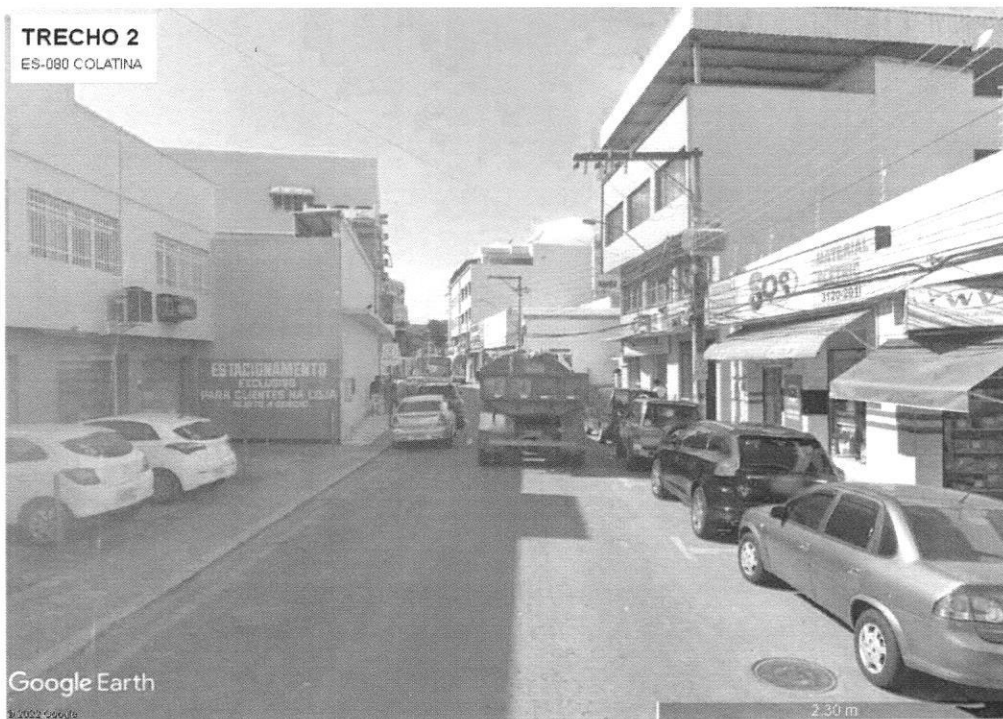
FOTO MOSTRANDO CONSTRUÇÕES, ILUMINAÇÃO PÚBLICA E CALÇADAS
